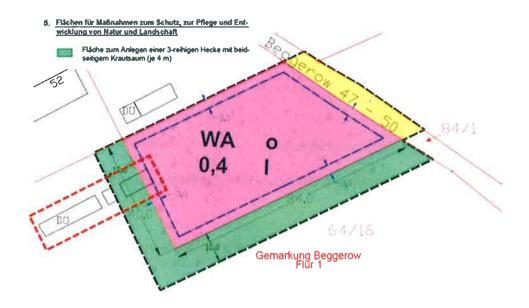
Ausschnitt Bebauungsplan Nr.3 "Wohnbebauung Beggerow", Kennzeichnung vorhandener Garagen (rot-gestrichelt), Angedachte Kompensationsflächen (grün)
